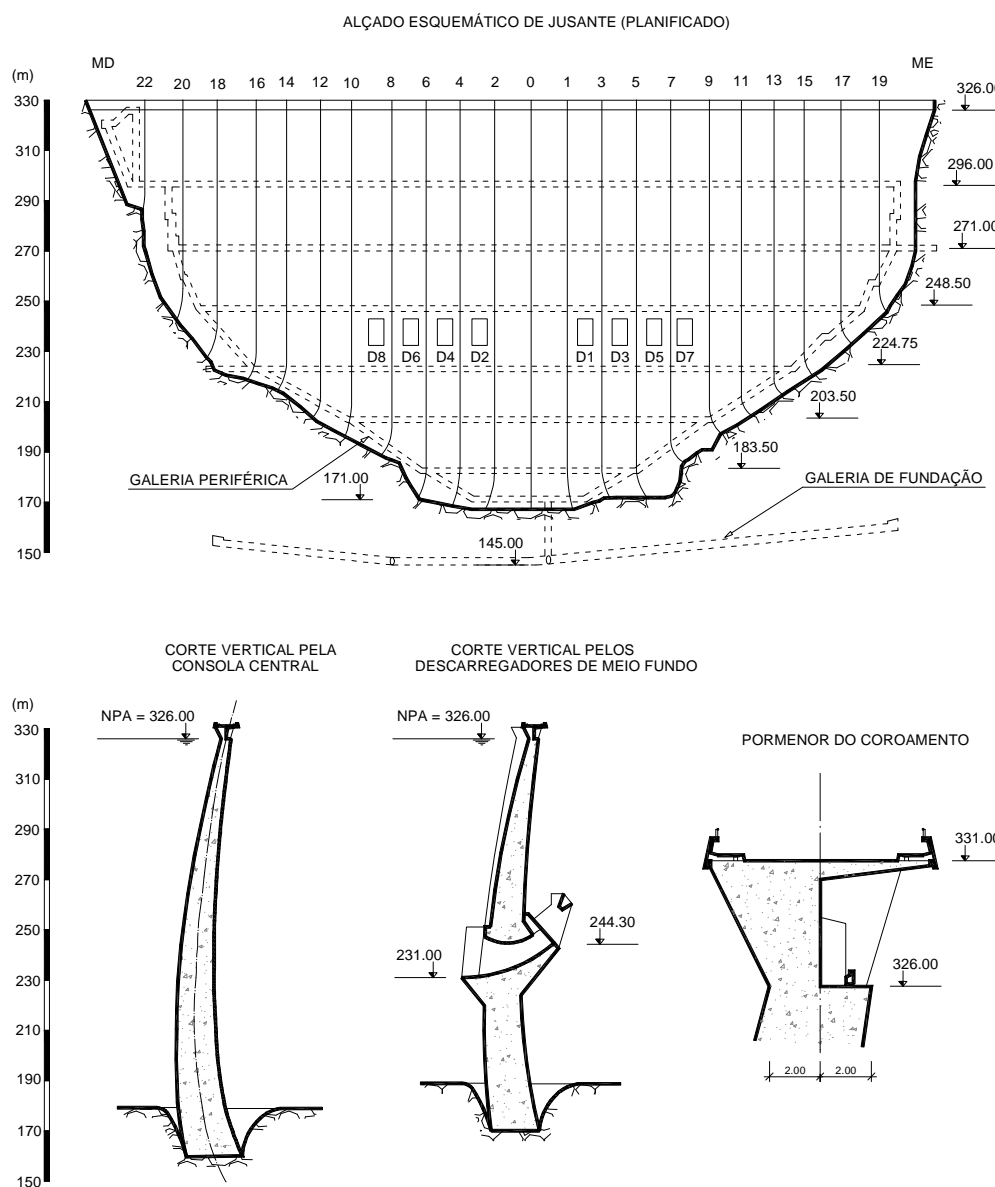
Barragem de Cahora Bassa. Alçado esquemático de jusante (planificado), cortes verticais e pormenor do coroamento (fonte: LNEC)
